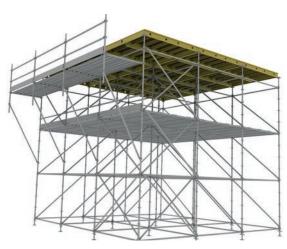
Échafaudage de soutien, par exemple pour le bétonnage de dalles
